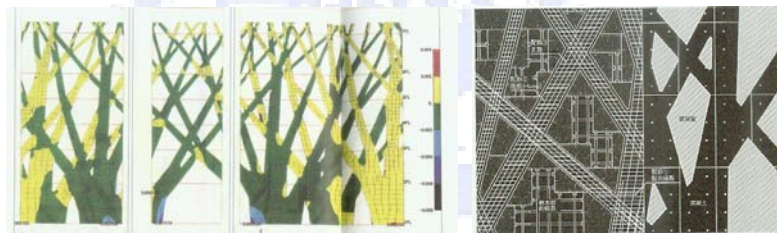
1：TOD'S 一案配筋與施工大樣圖 2：Mikimoto 的鐵板夾混凝土三明治結構工廠施工情形
